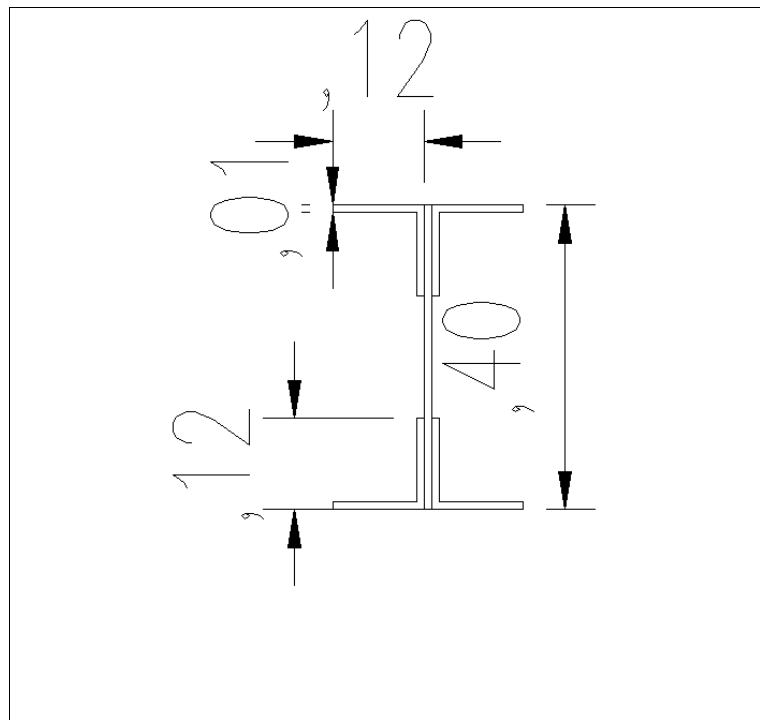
Sección del elemento tipo 3-25, Puente 2. Fuente (Autores).
